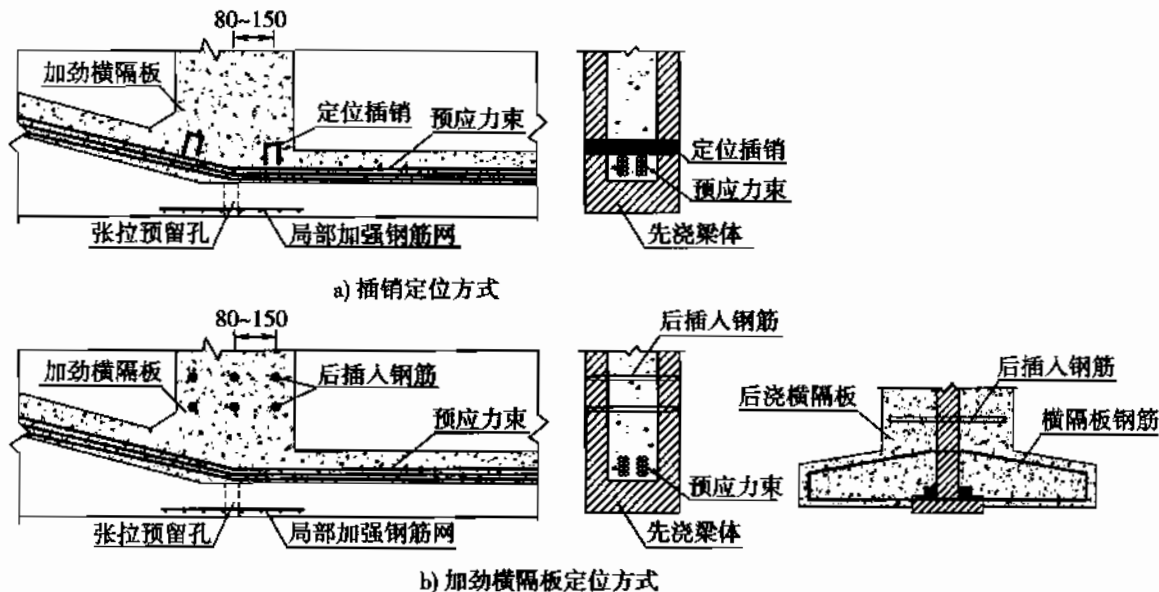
张拉孔处及加劲横隔板的加强钢筋构造(尺寸单位:mm)
